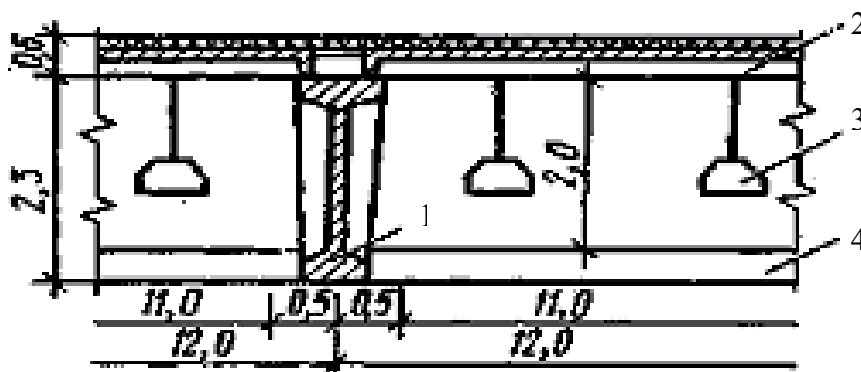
Пример конструкции балочного покрытия зала пролетом 48 м:
